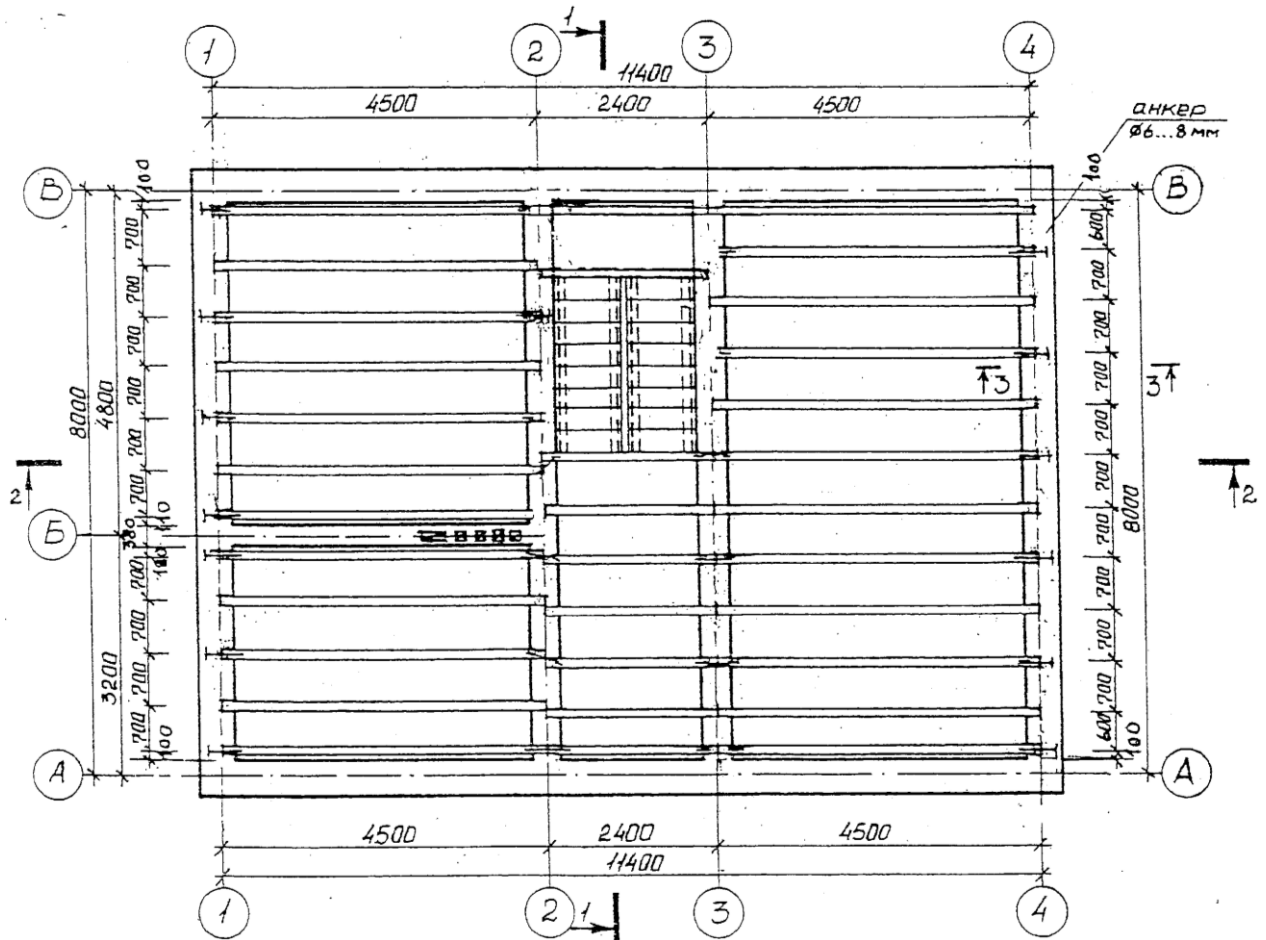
Приклад оформлення плану міжповерхового перекриття
